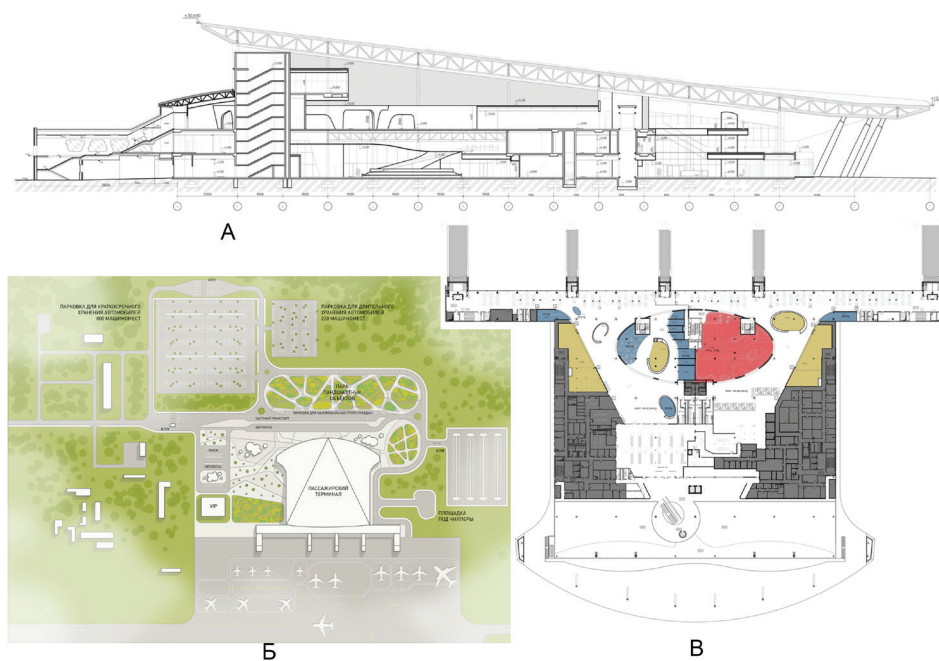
Проектное решение аэропорта Курумоч, Самара: А – поперечный разрез; Б – транспортная схема; В – план второго этажа
